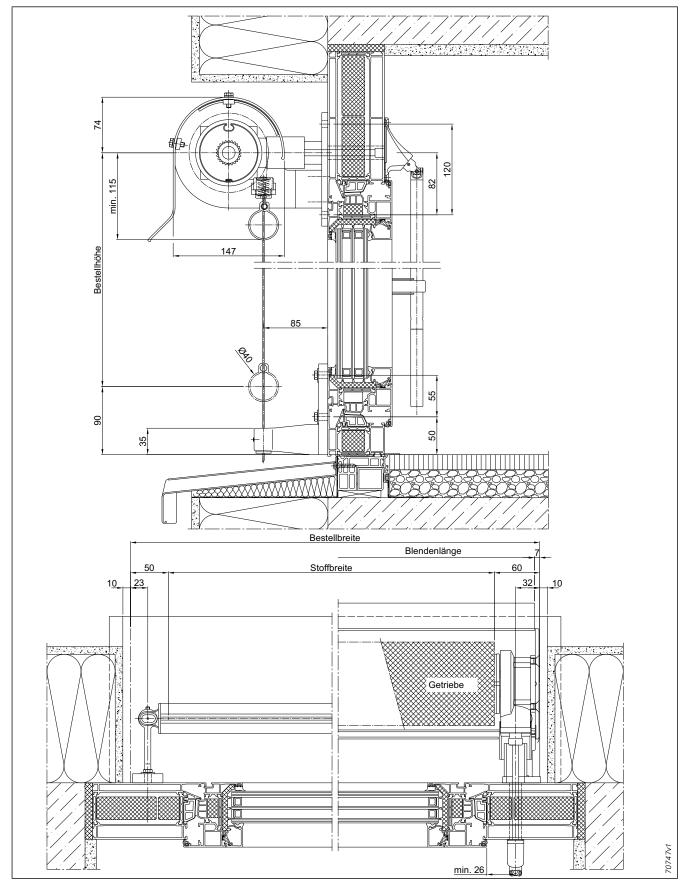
Fassaden-Markise 207 mit Halbrundblende Typ 2.3 in Laibung montiert
